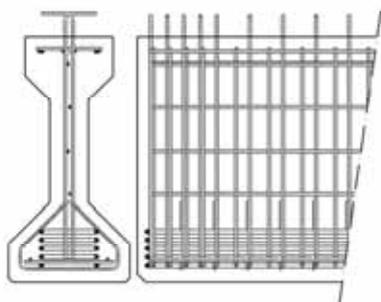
Esempio di barra compressa instabilizzata in una trave (immagine tratta da N. S. Anderson, J. A. Ramirez, "Detailing of stirrups reinforcement", ACI Structural Journal, Vol. 86, N. 5, 1989, pag. 507-514)
